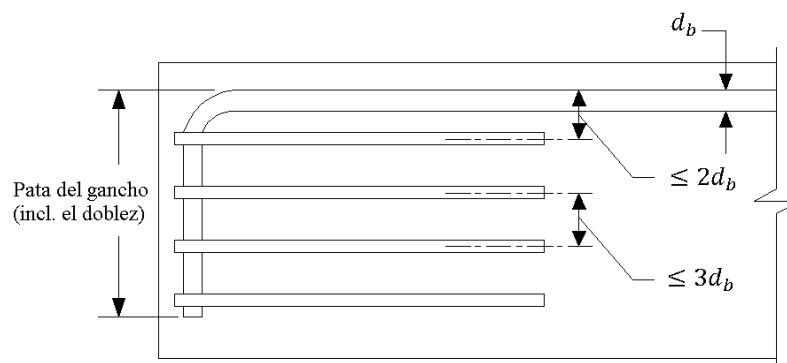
24. Estribos colocados paralelamente a la barra en desarrollo, espaciados a lo largo del gancho más el doblado. [ACI 318 (2005)]
